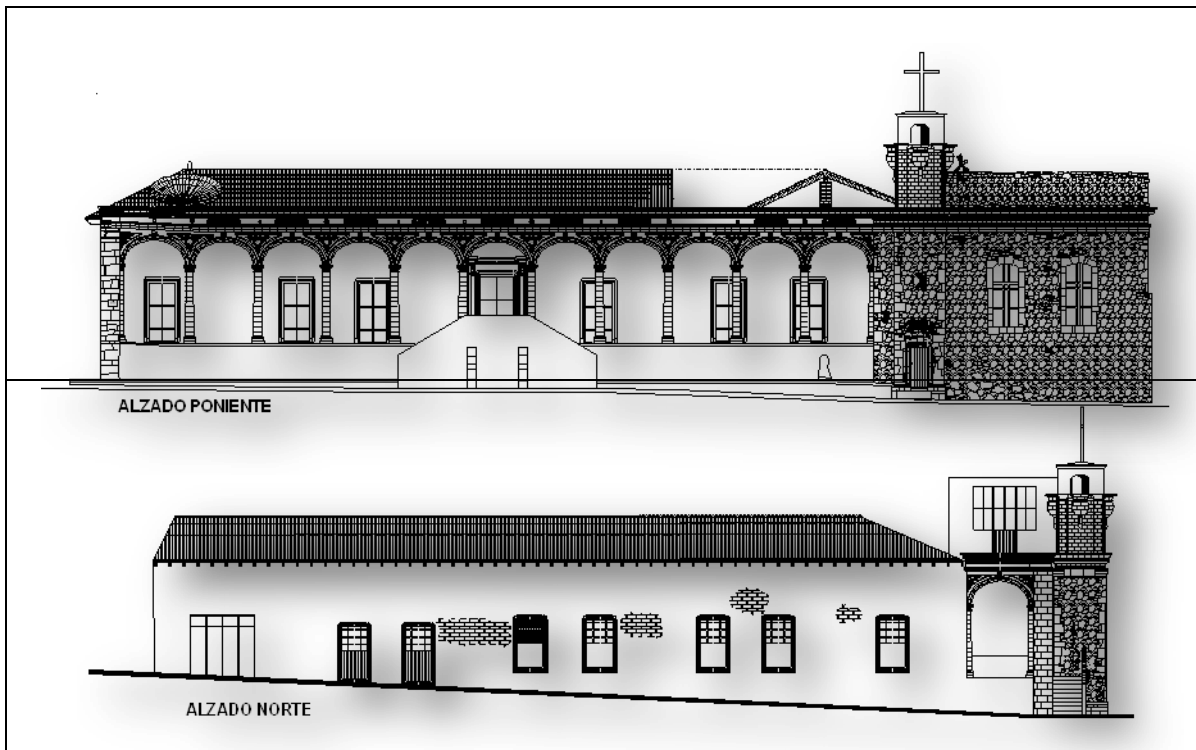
Vista de las Fachadas poniente y norte del casco de la ex hacienda de la Sauceda.
